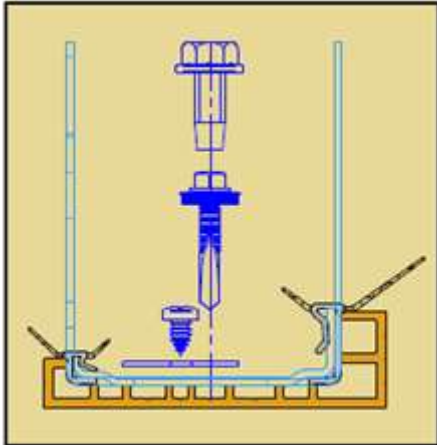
Bovenaansluiting poort – verbeterde uitvoering, verticale snede. ³³
